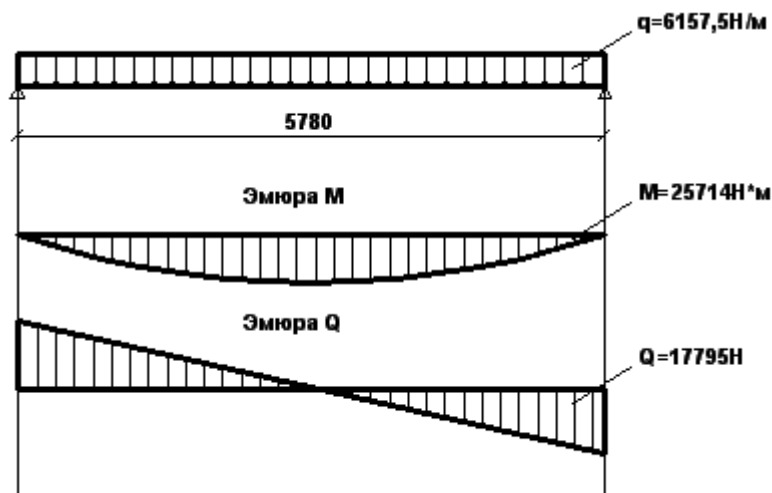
Расчетная схема плиты перекрытия в стадии эксплуатации, эпюра изгибающих моментов и эпюра поперечных сил
